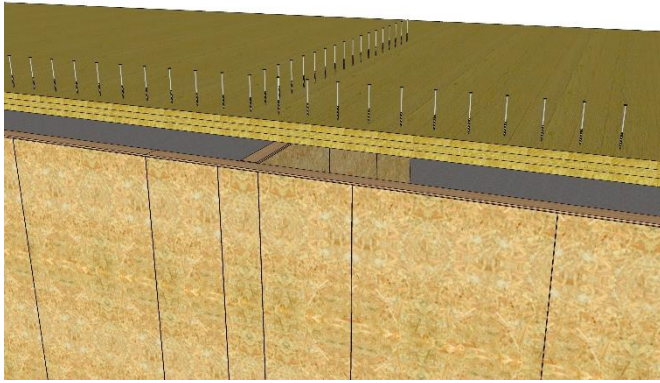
Mise en œuvre du plancher bois contrecollé (CLT) / Vissage sur les traverses hautes en tête de panneau
